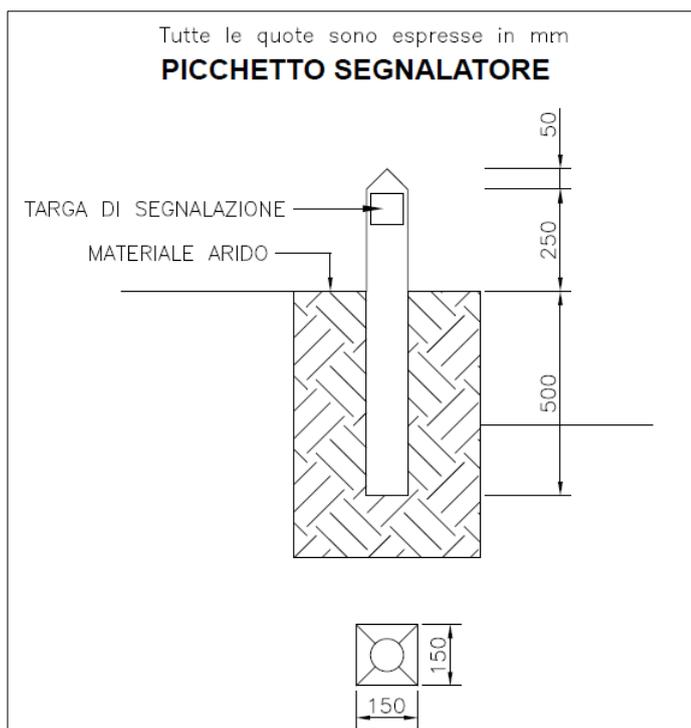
Sezione tipica del picchetto segnalatore
